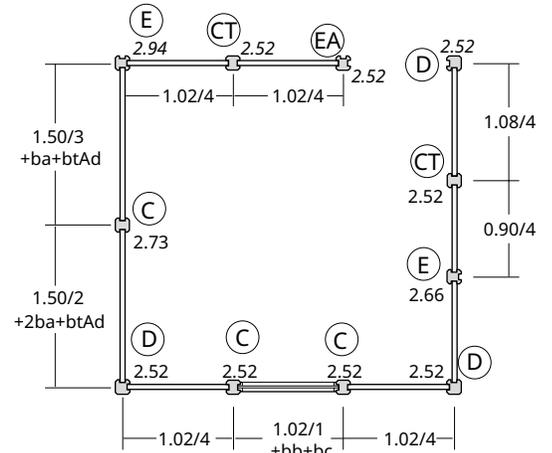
Ejemplo de distribución de columnas y baldosas
